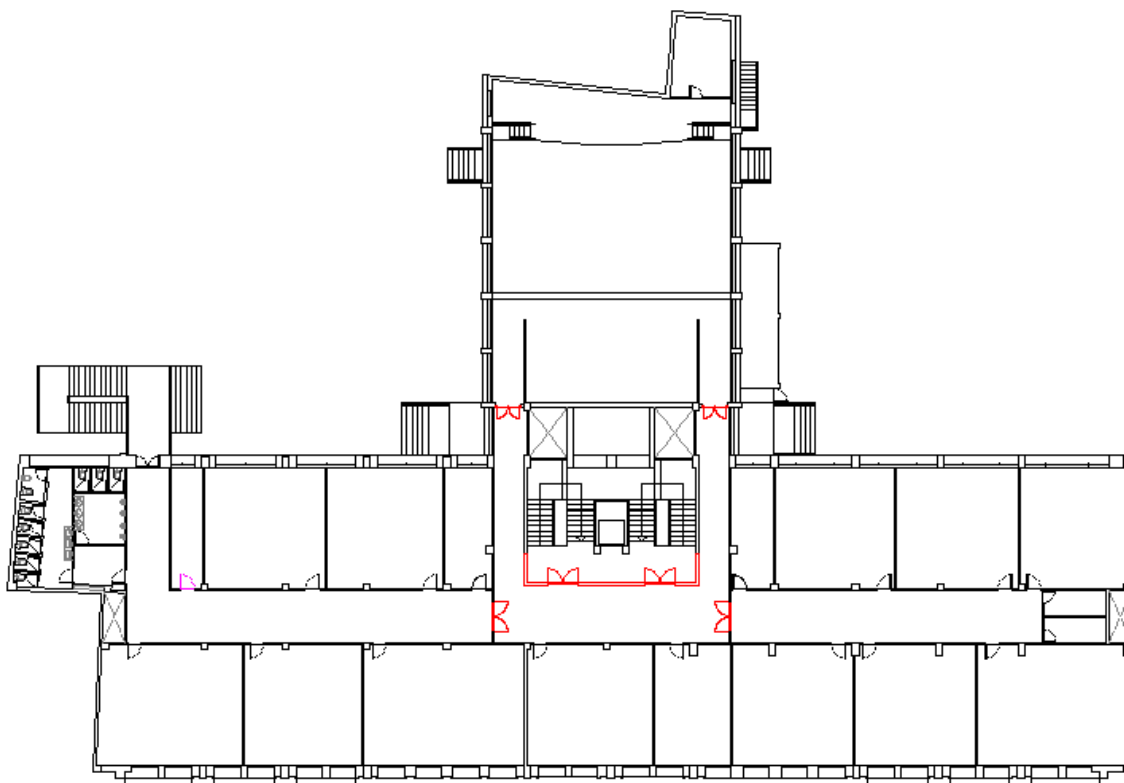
Propuestas de actuación en puertas planta primera. Fuente: Elaboración propia.
